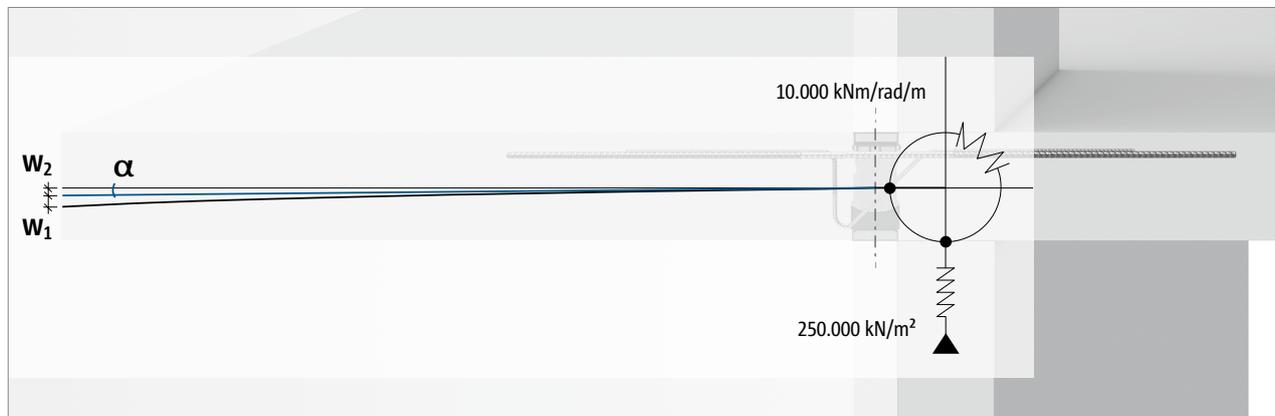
Verformung einer Balkonplatte mit Schöck Isokorb®
